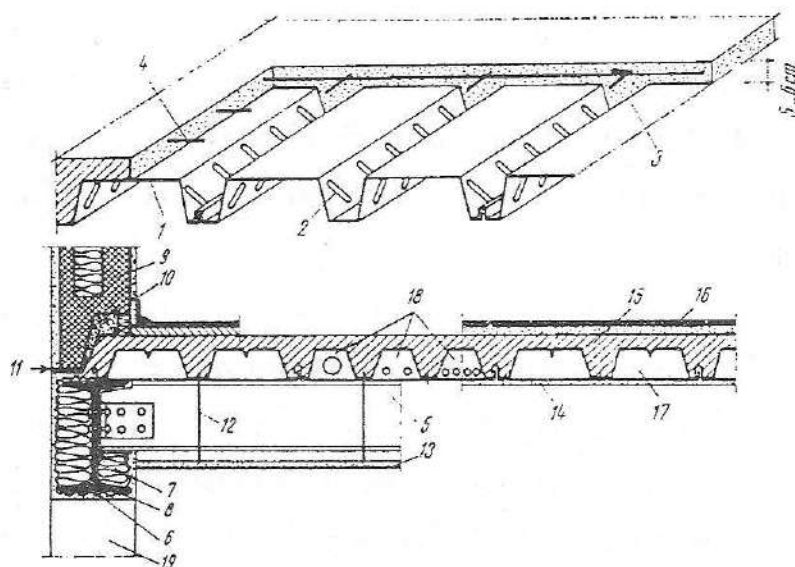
Vedere și secțiune transversală printr-un planșeu mixt:
